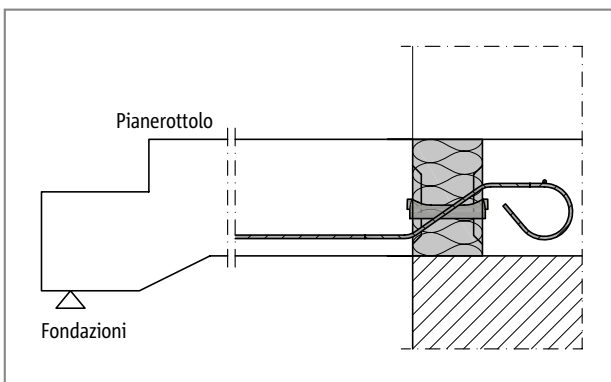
Schöck Isokorb® tipo QXT: raccordo pianerottolo delle scale con appoggio su muratura termoisolante monostrato (tipo da QXT10 a QXT40)
